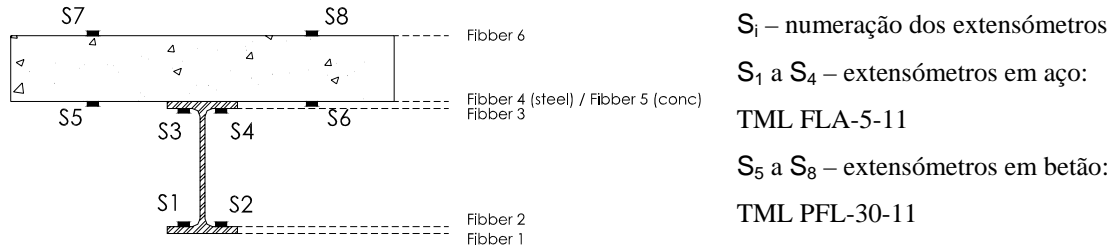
Disposição dos extensómetros eléctricos na secção transversal da viga mista
